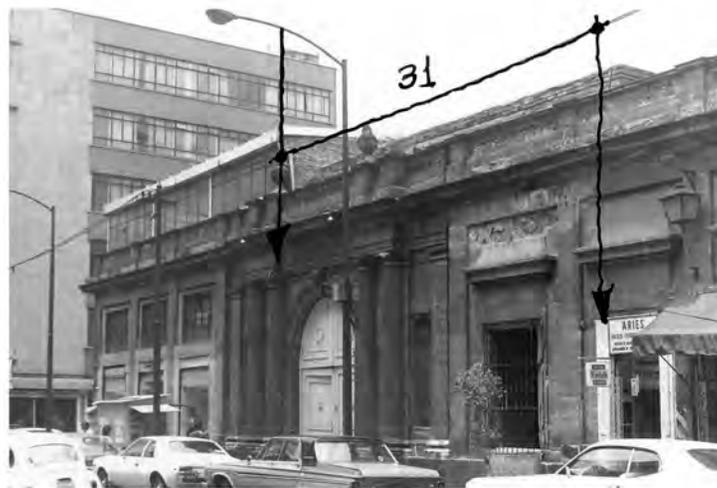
Apertura de vanos en las cornisas de la esquina y construcción en planta alta.
